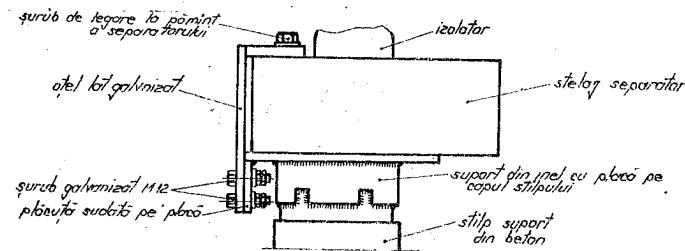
Detaliu de legare la pămînt a unui separator montat pe suport din beton.
